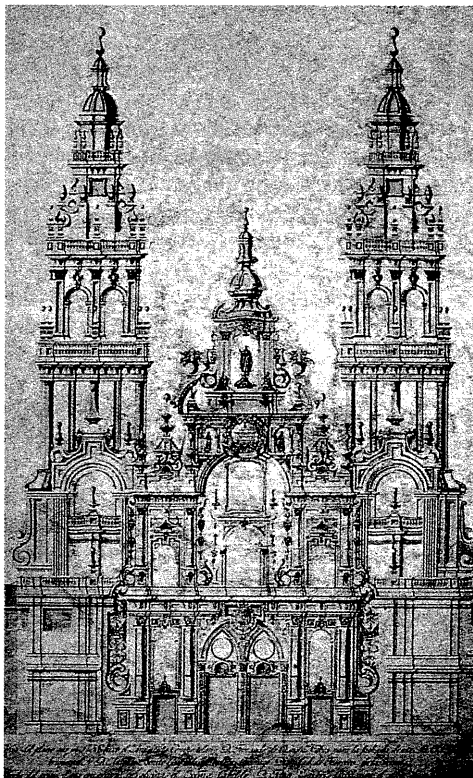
Proyecto de Fernando de Casas para la fachada del Obradoiro. Copia de J. Esmoris.
